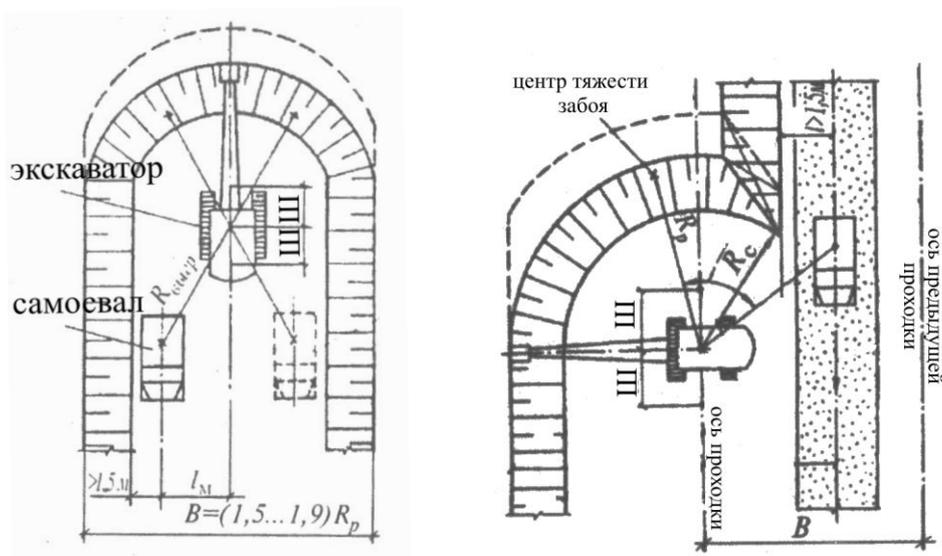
Разработка грунта экскаваторами с рабочим оборудованием «прямая лопата»
